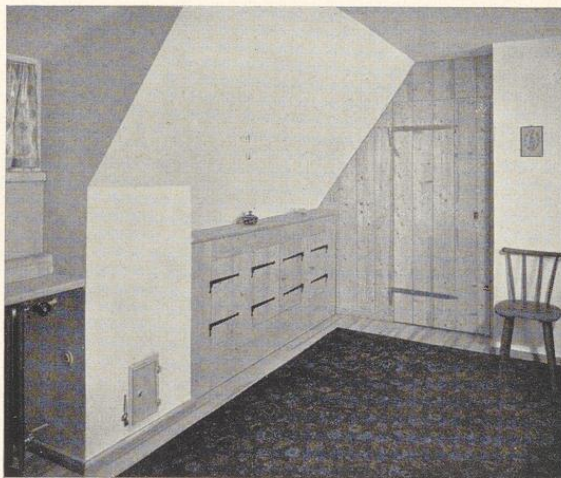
Einfaches Dachzimmer, gut ausgeputzt
